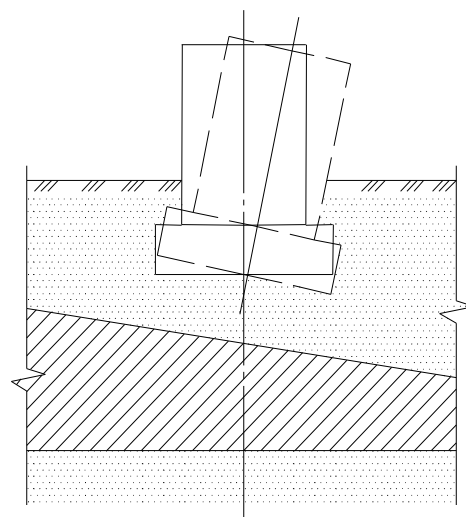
Вплив нашарувань шарів ґрунту на крен фундаменту
